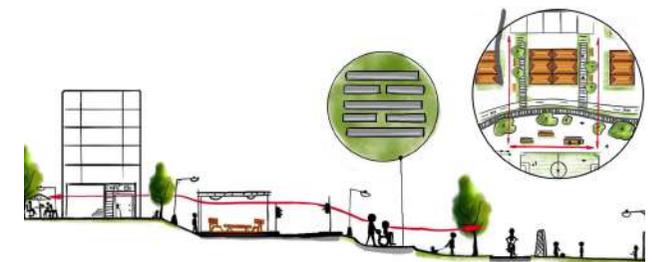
Caminerías en parques, conexión entre el parque y los edificios de vivienda
